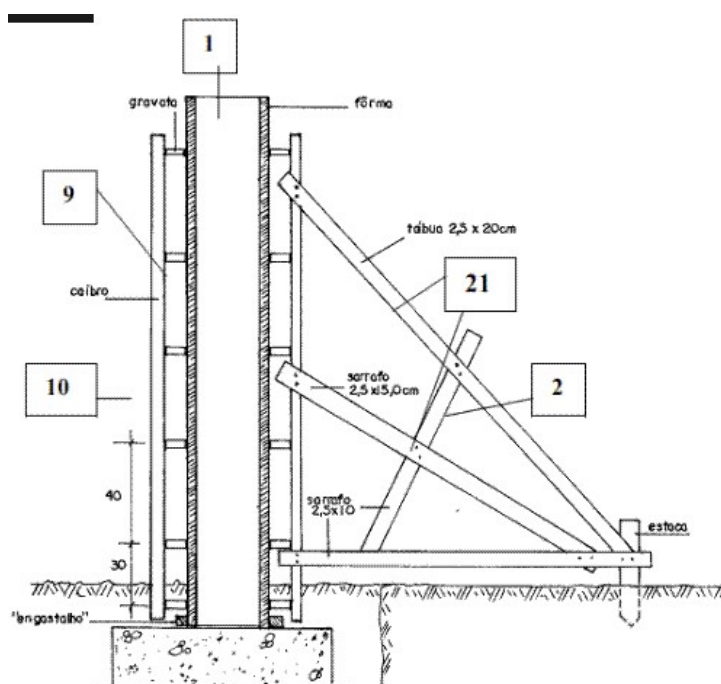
Sistema de Fôrmas para pilares. [Fonte: Blog da Construção]
